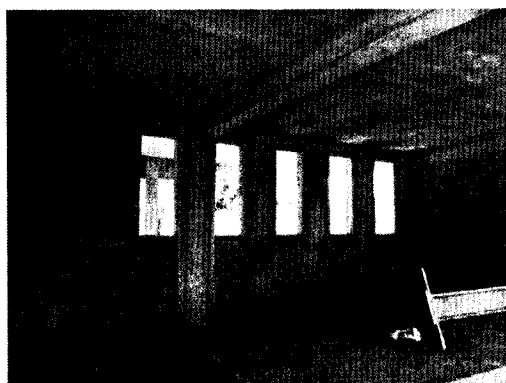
Construção de estrutura e alvenaria do bloco pátio e cozinha.
